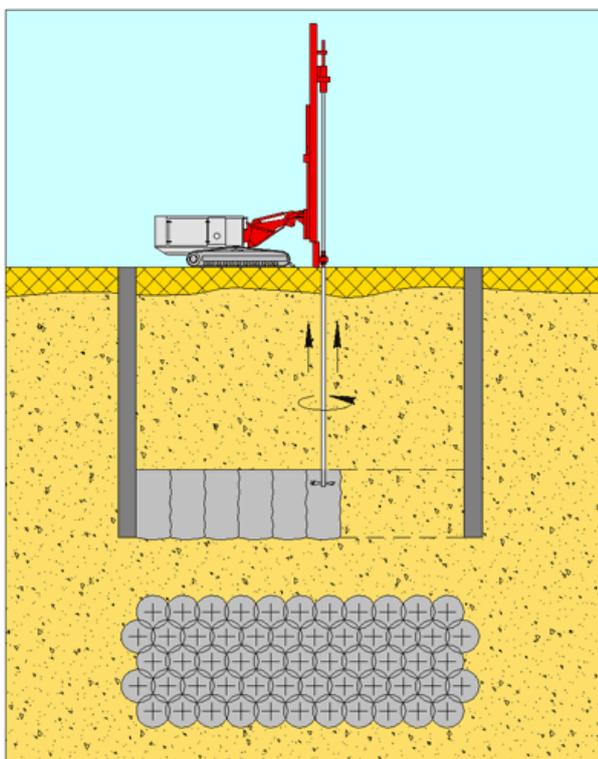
Схема устройства горизонтальной противофильтрационной завесы в днище котлована
